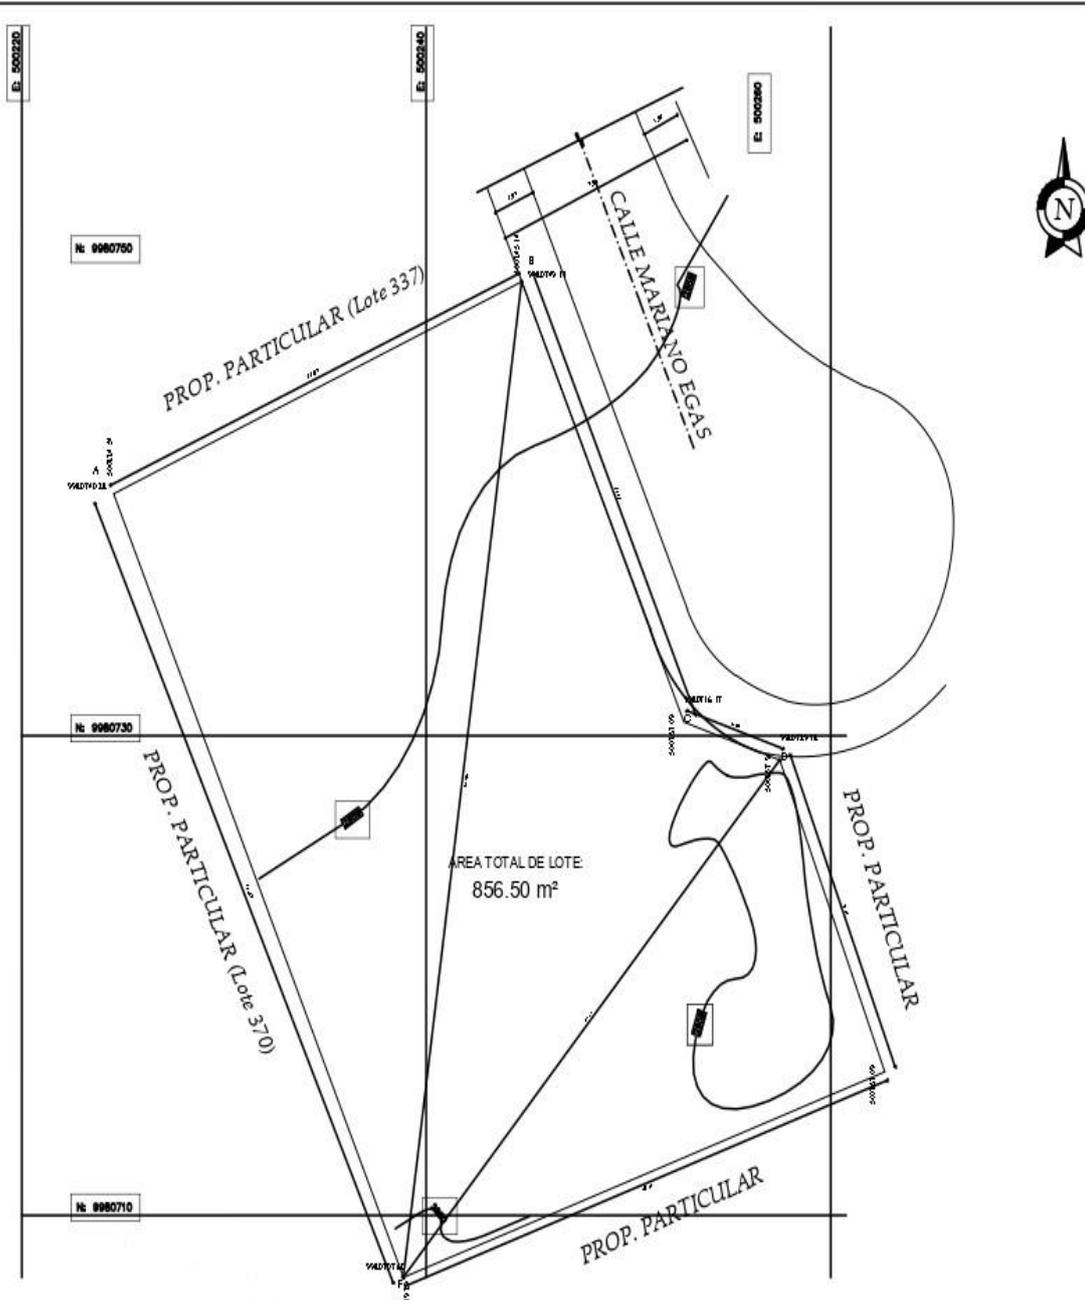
Levantamiento Topográfico Proyecto AETHOS 3
